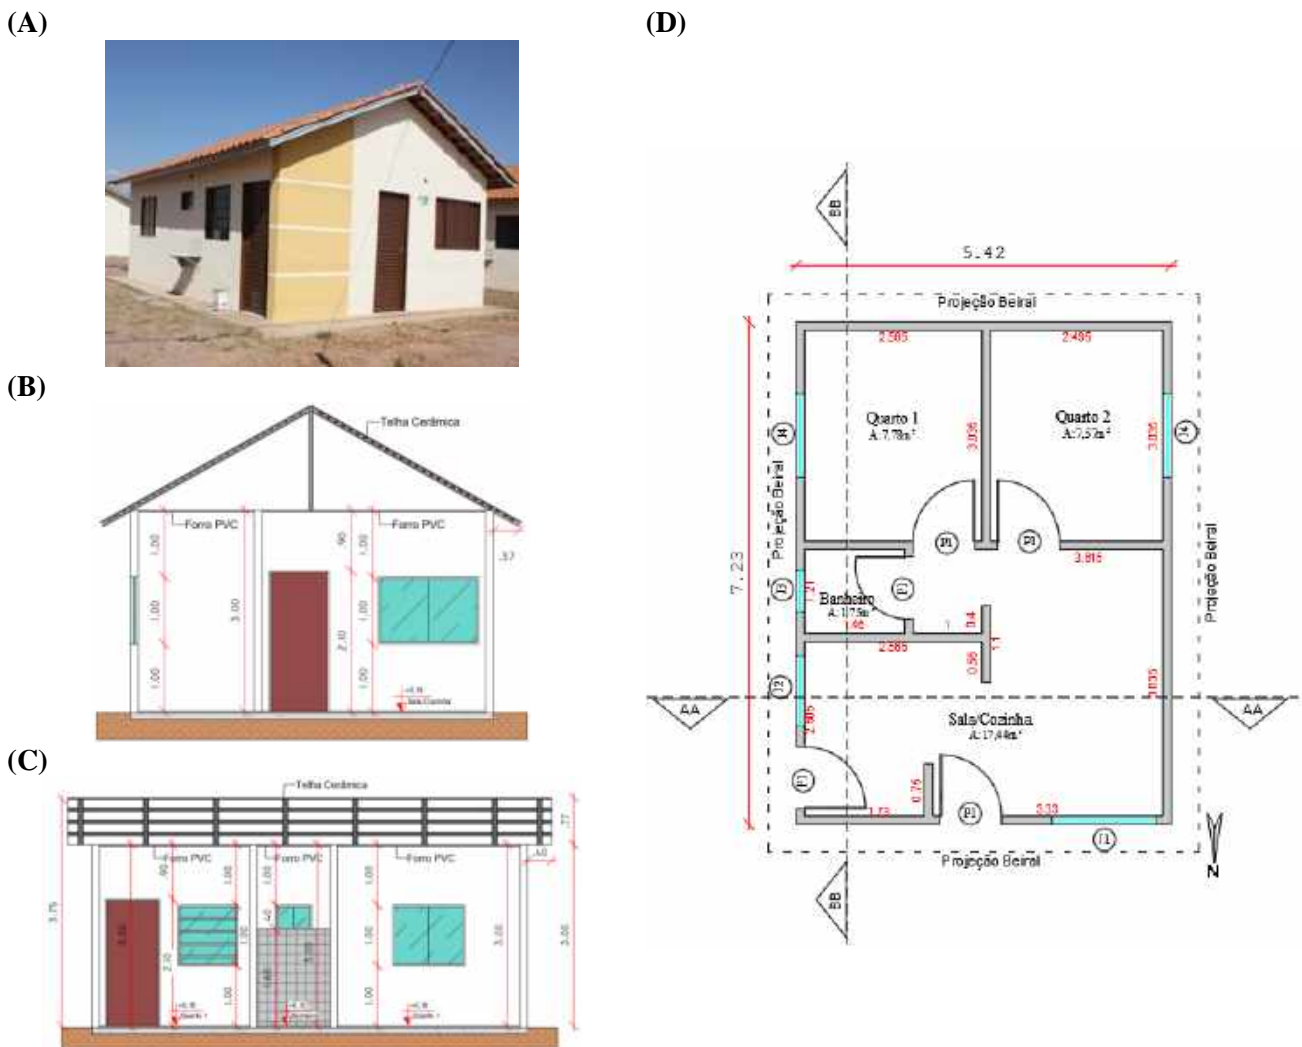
Objeto de Estudo (Tbase): (A) Edificação Construída; (B) Corte AA; (C) Corte BB e (D) Planta Baixa (Autores, 2019).
